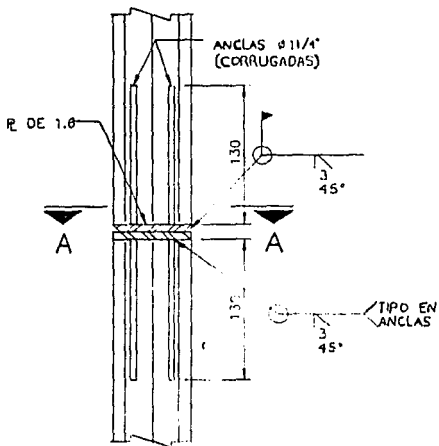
Soldadura de pilotes en dos tramos.
